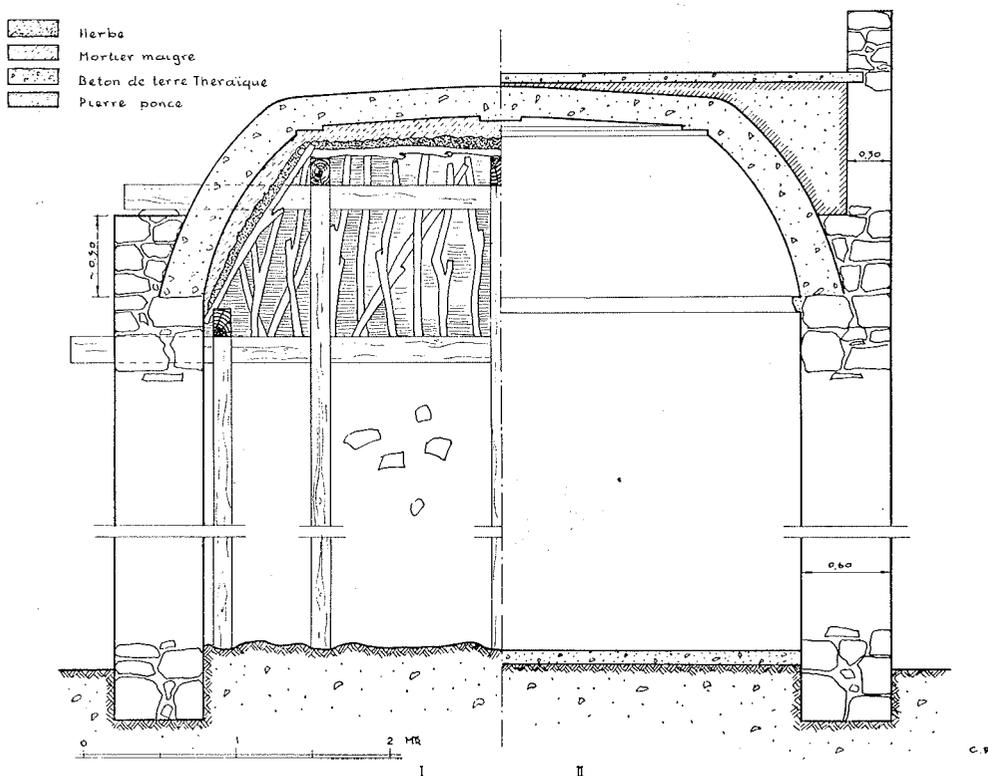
Stade moyen et état final de la construction d'un « scaphi »
